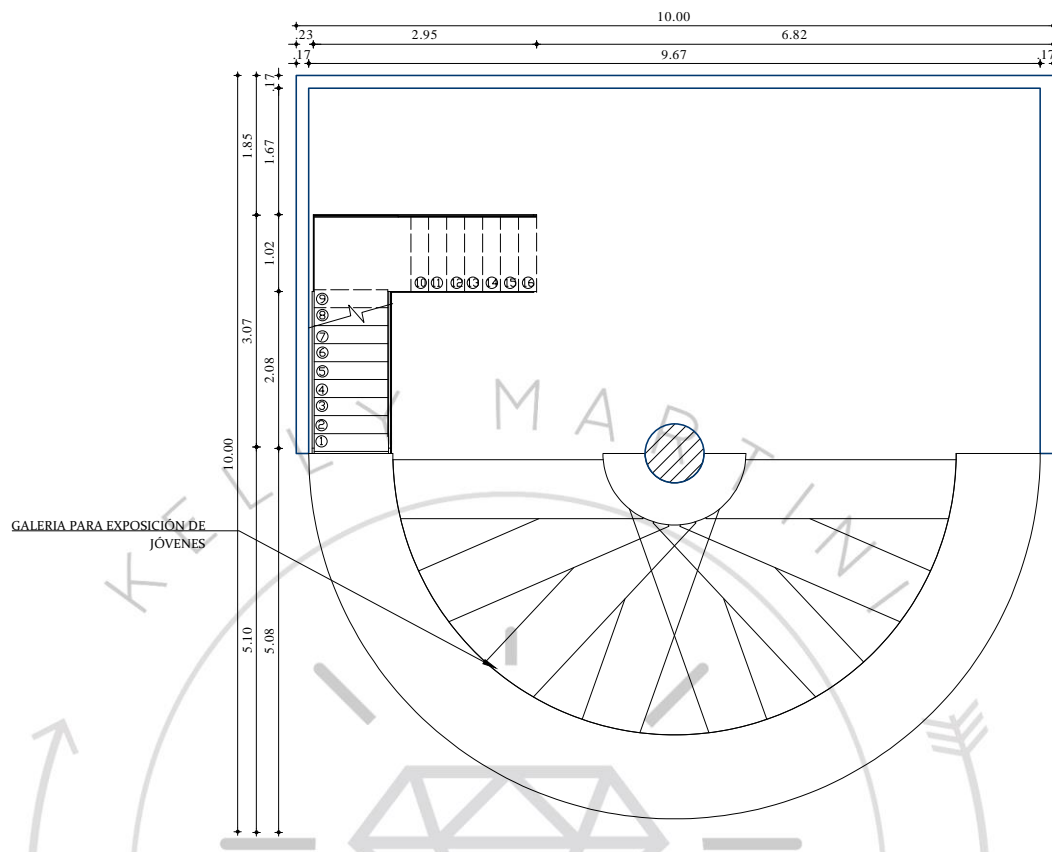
Primera planta Folie 04. Por Kelly Vanegas.
